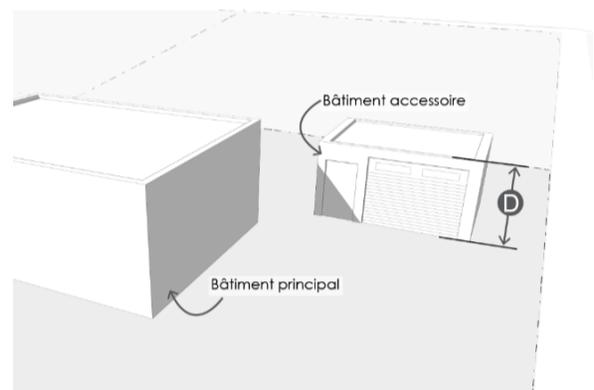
Mesure de la hauteur d'un bâtiment accessoire
